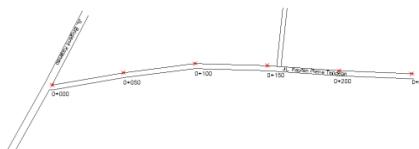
Layout situasi Jalan Kapten Piere Tendean
